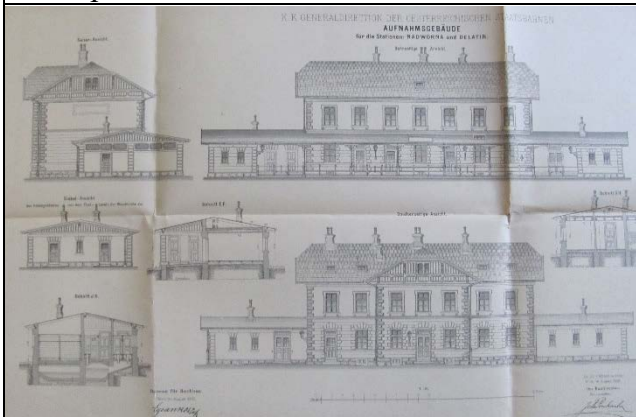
Фрагмент креслення фасадів будівель вокз. станц. Надвірна, Делятин [23]
